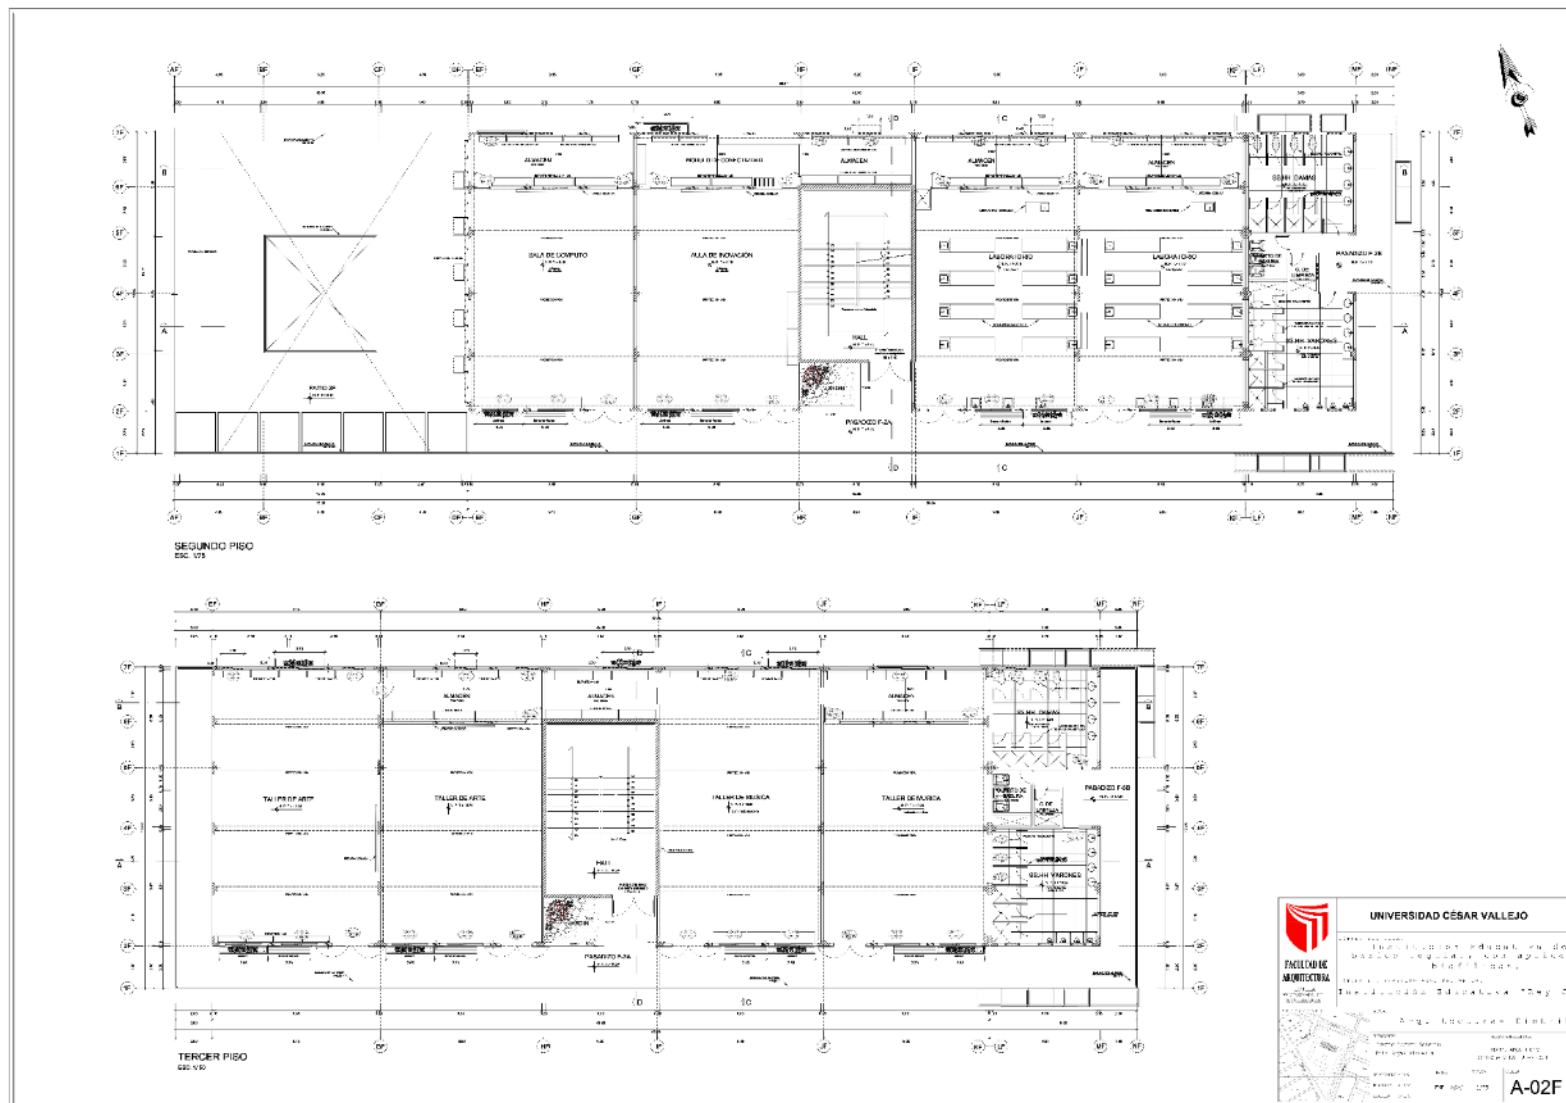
Plano segunda y tercera planta bloque "F", Fuente: elaboración propia
